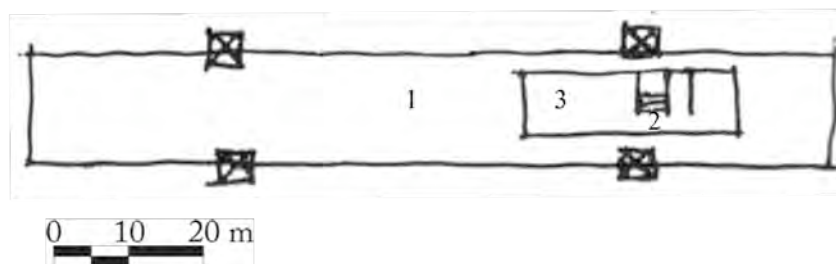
Museu da Civilização (1962) – elevação – croqui.
